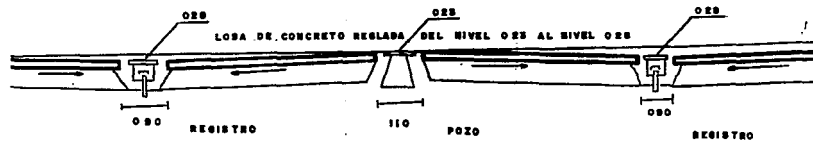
CORTE LONGITUDINAL DE UNA CALLE TIPO.
